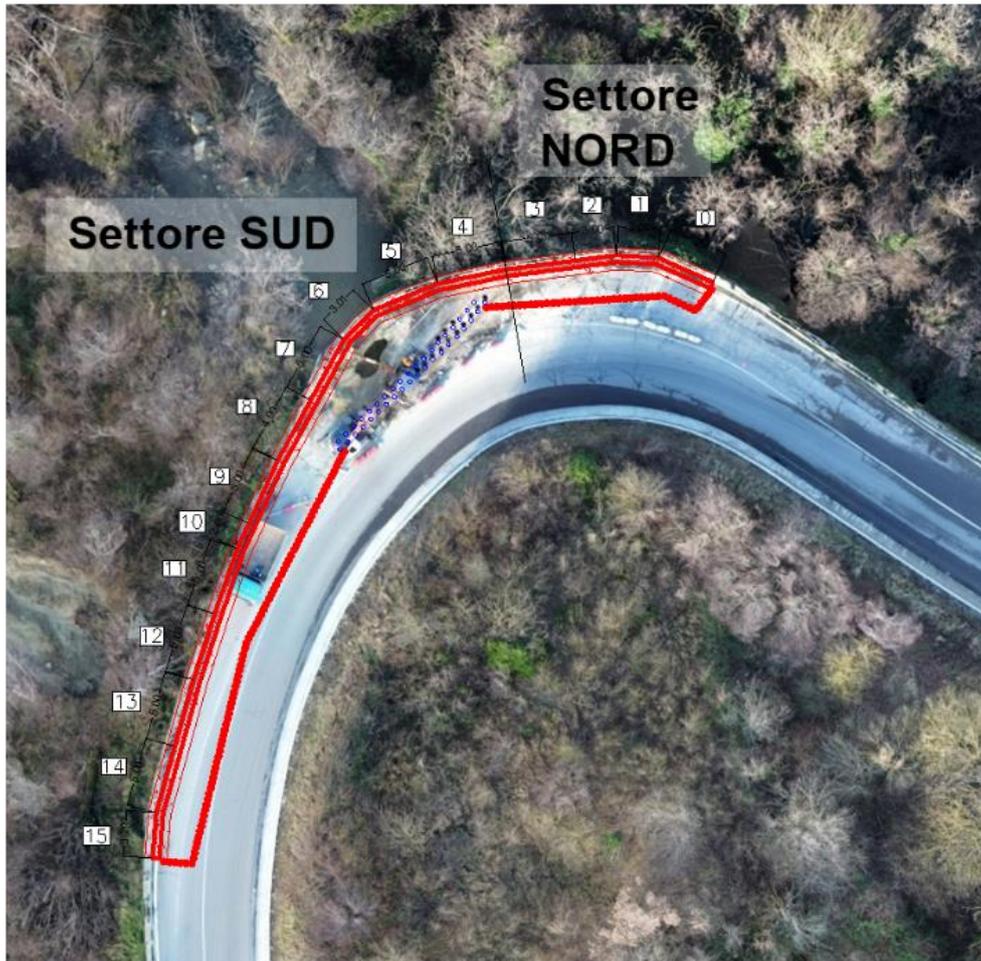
Planimetria dell'opera con indicazione dei settori di intervento
